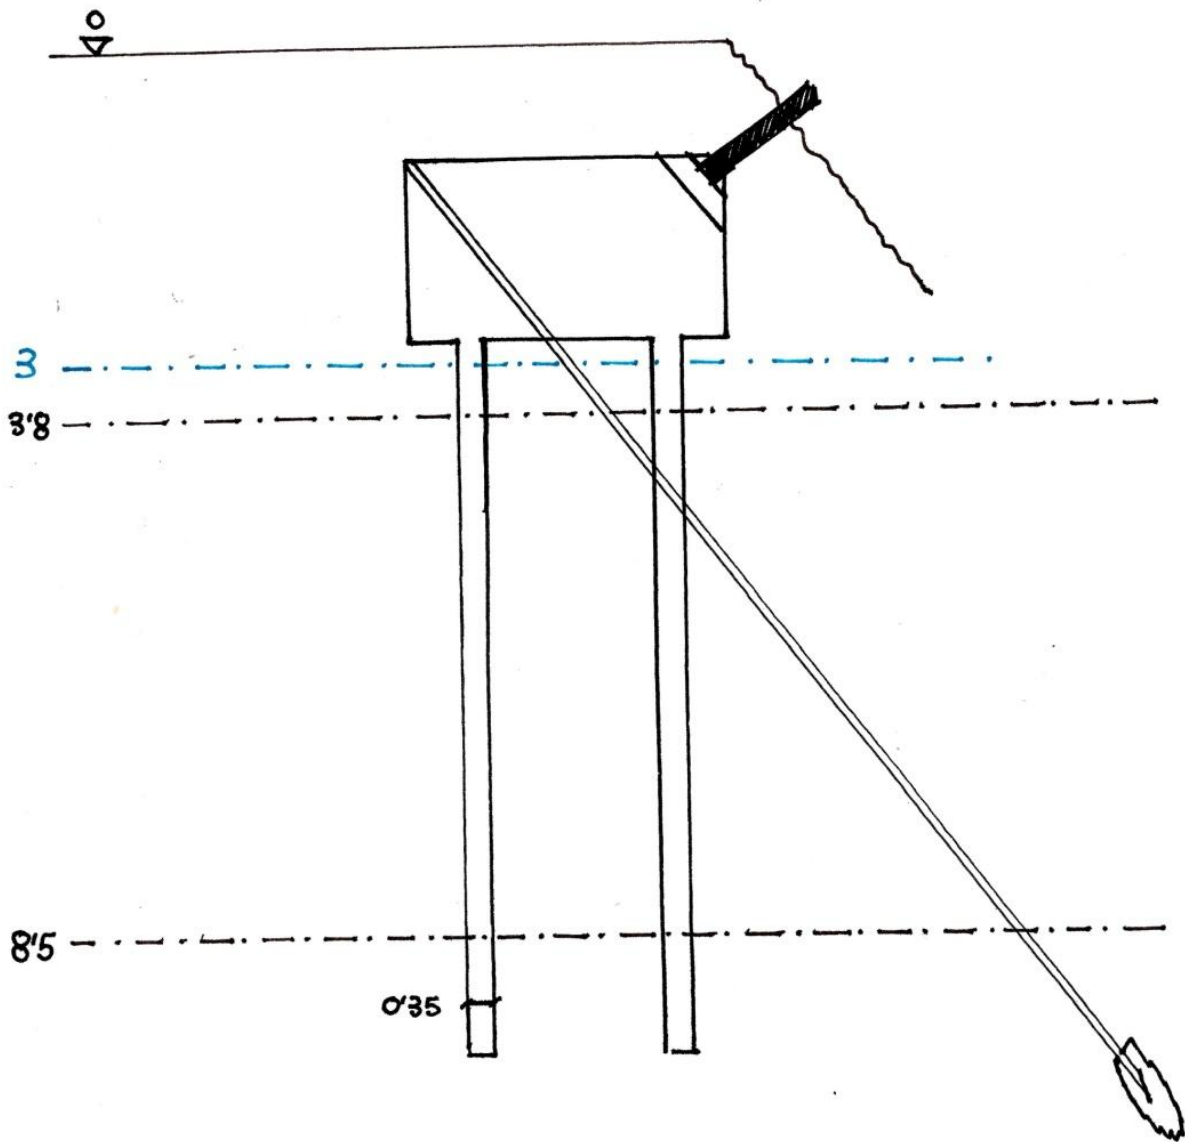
Esquema de cimentación profunda en el estribo del arco.
